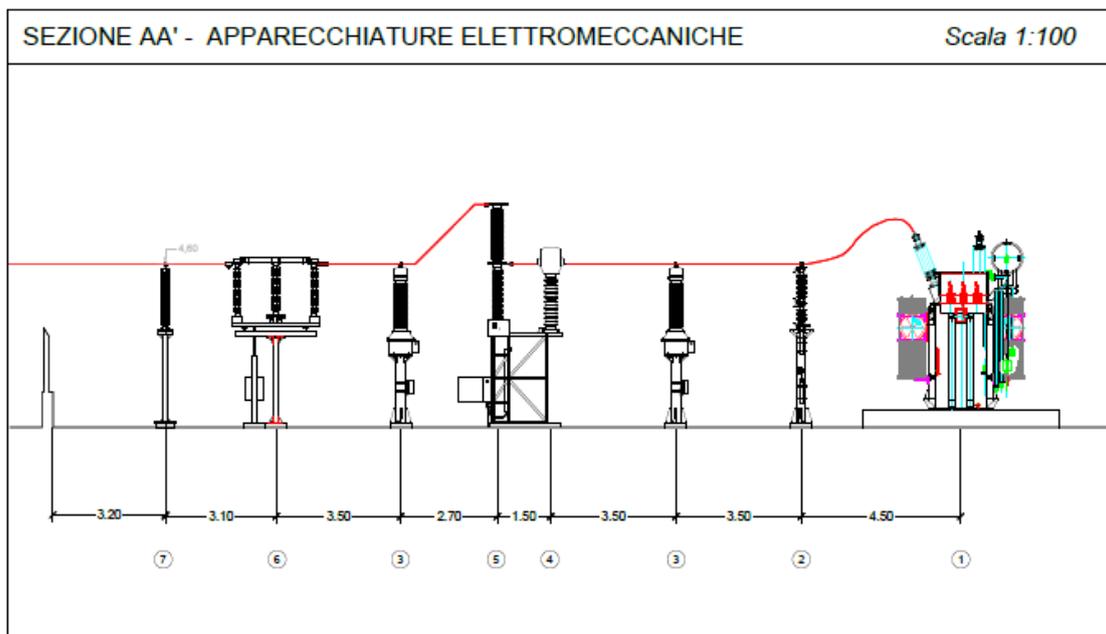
Sezione A-A' - Sistema di sbarre di raccolta AT
